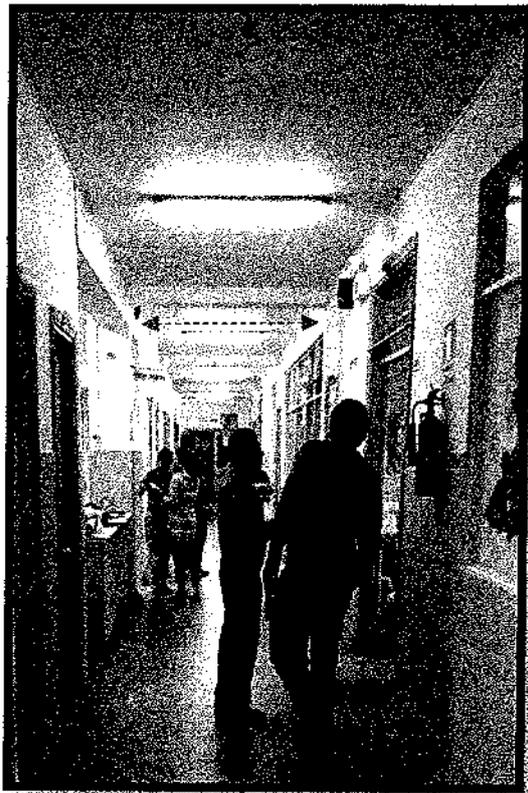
SISTEMA ESTRUCTURAL ENMARCADO (VIGAS Y COLUMNAS) EN AMBIENTE DE HOSPITALIZACIÓN.
